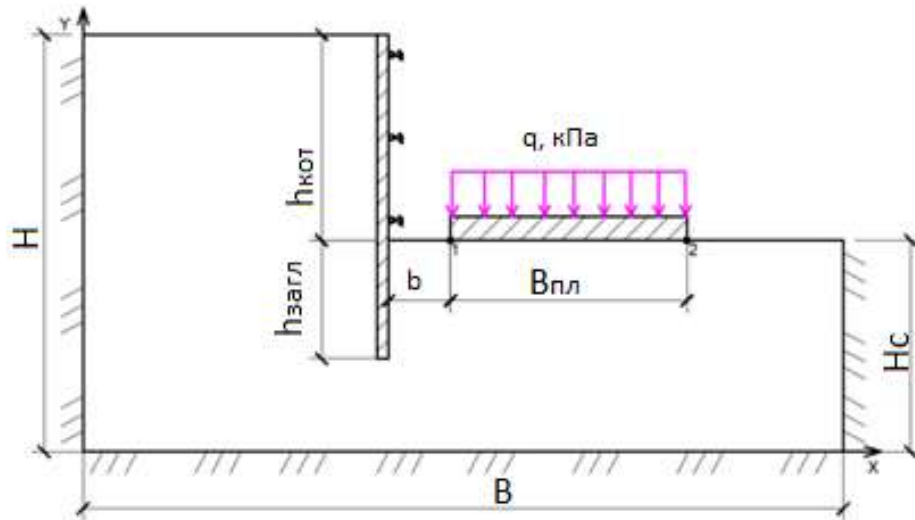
Розрахункова схема розташування будівлі, яка зміщена щодо огороження котловану
